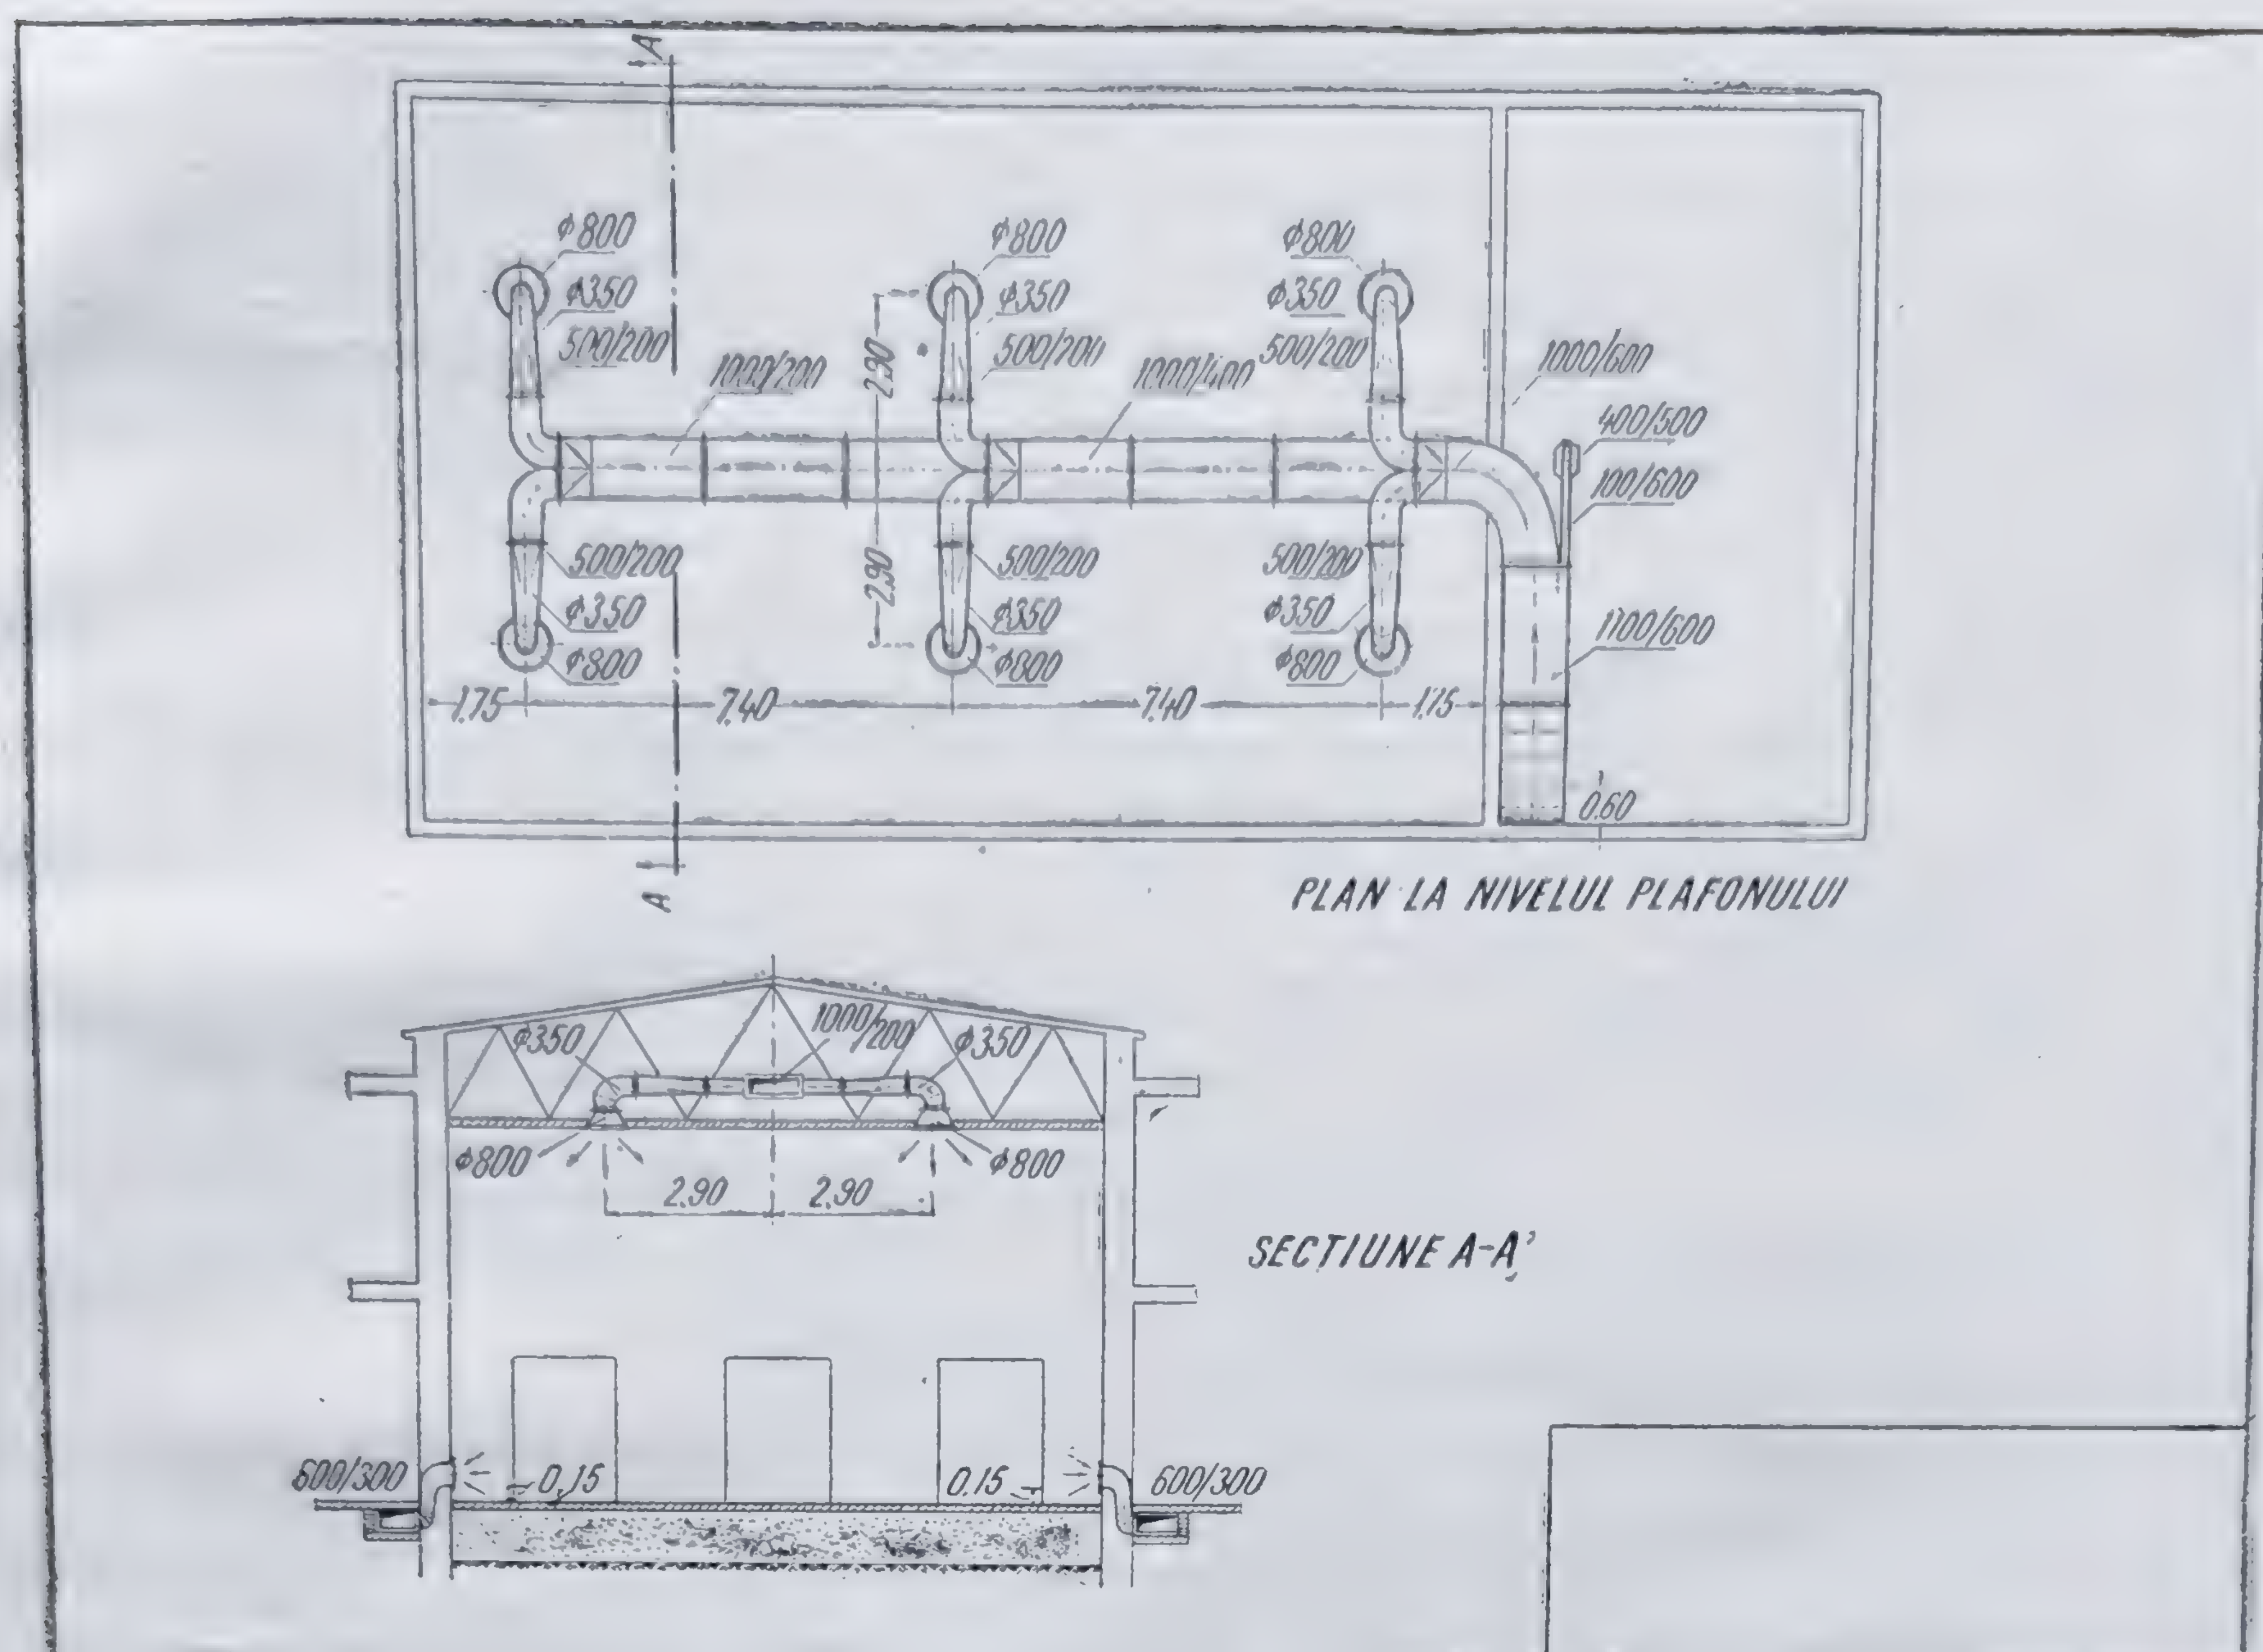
Desen pentru un proiect de instalație de încălzire cu aer cald.
